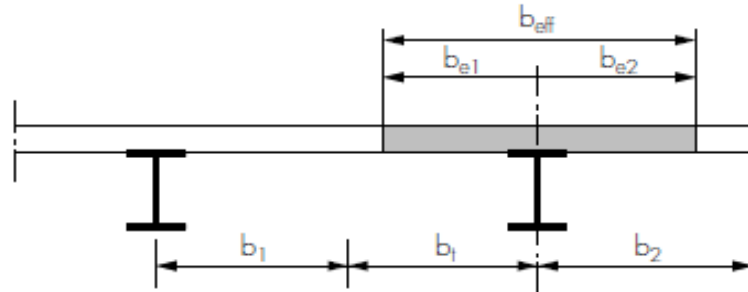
Largeur participante de la dalle pour une poutre mixte
